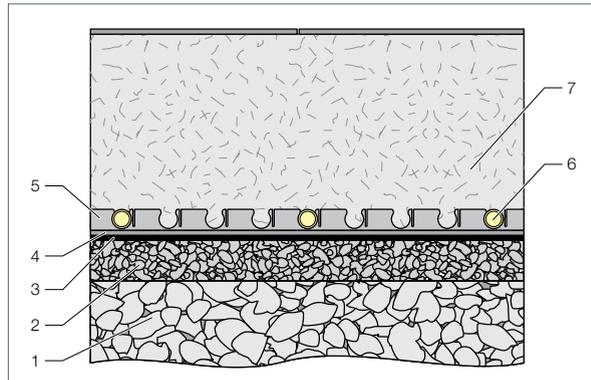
Aufbauvariante mit Stahlfaserbeton
